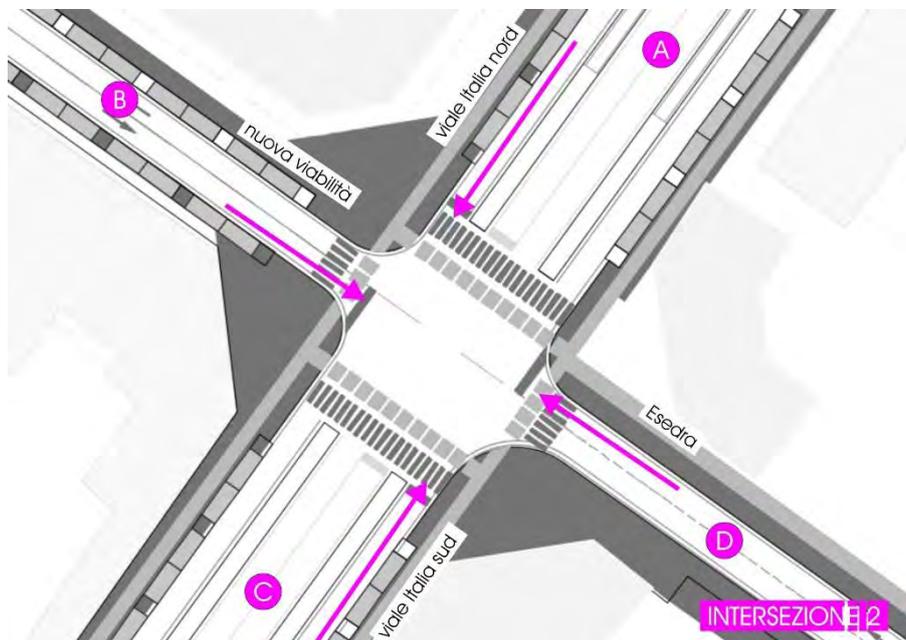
Scenario di Intervento 0 – Planimetria intersezione 2
